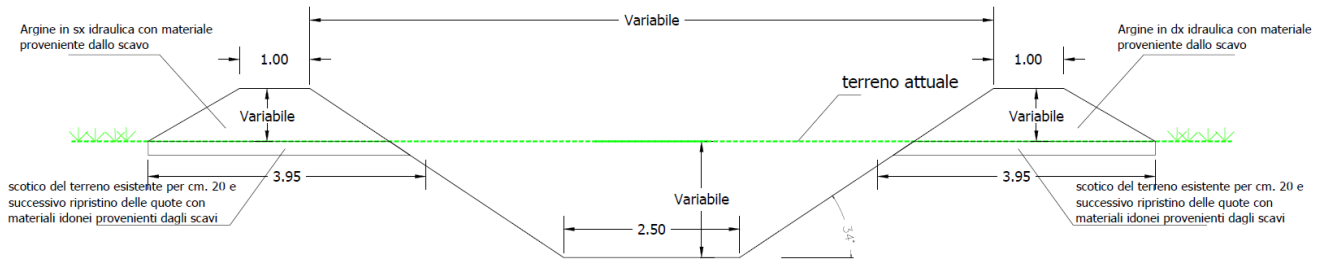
Sezione tipo - Canale a valle del 4 attraversamento - sezioni da 31V in poi
